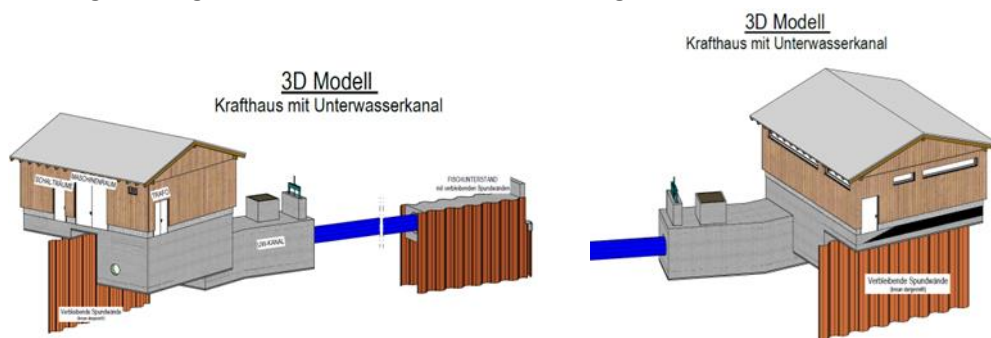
und 50: 3D Ansicht Krafthaus mit Unterwasserkanal und Auslaufbauwerk
